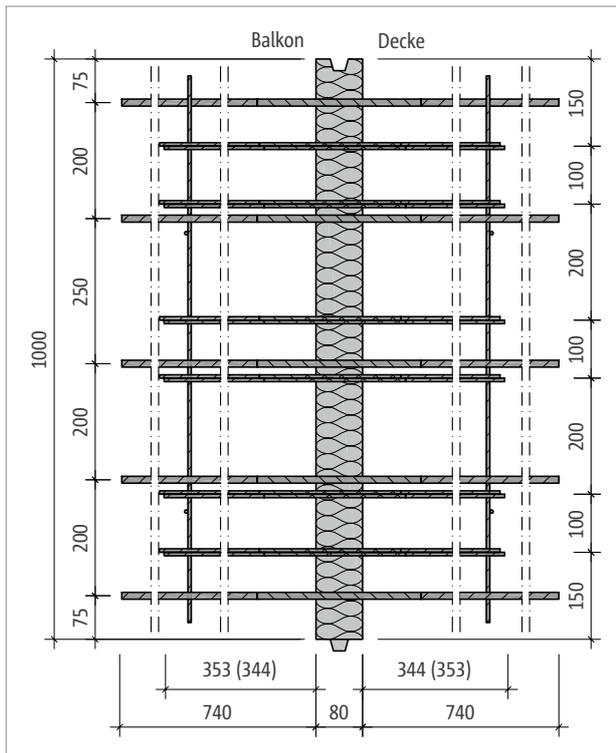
Schöck Isokorb® T Typ D-MM2-VV1: Grundriss
